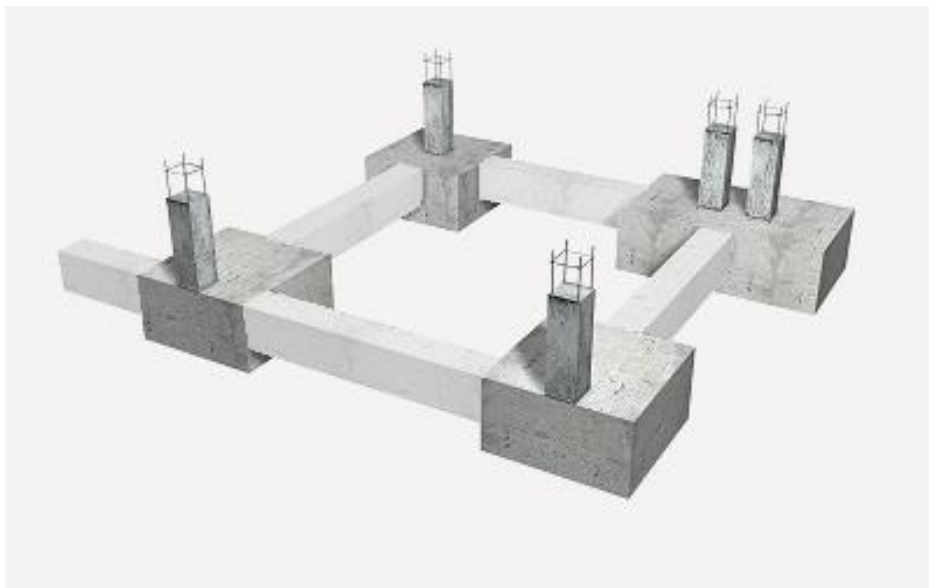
Cimiento con concreto, fuente: manual de vivienda
